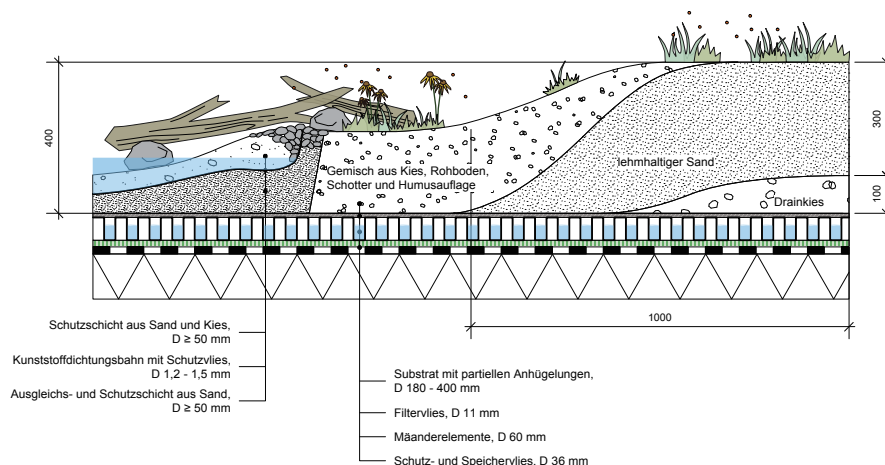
Schematischer Schnitt Dachbegrünung Typ I: Trockenrasen
